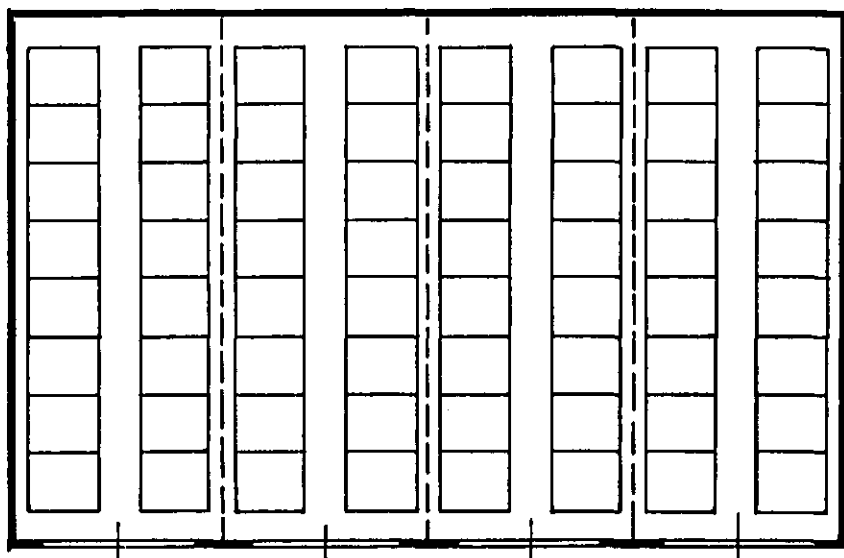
Alle rijen trekbanken naast elkaar zonder voorpad.
